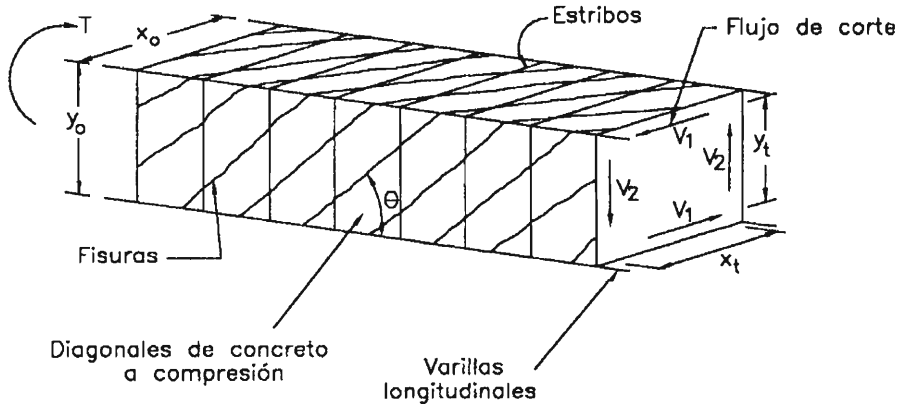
Idealización del elemento de concreto armado sometido a torsión según la teoría de la armadura
